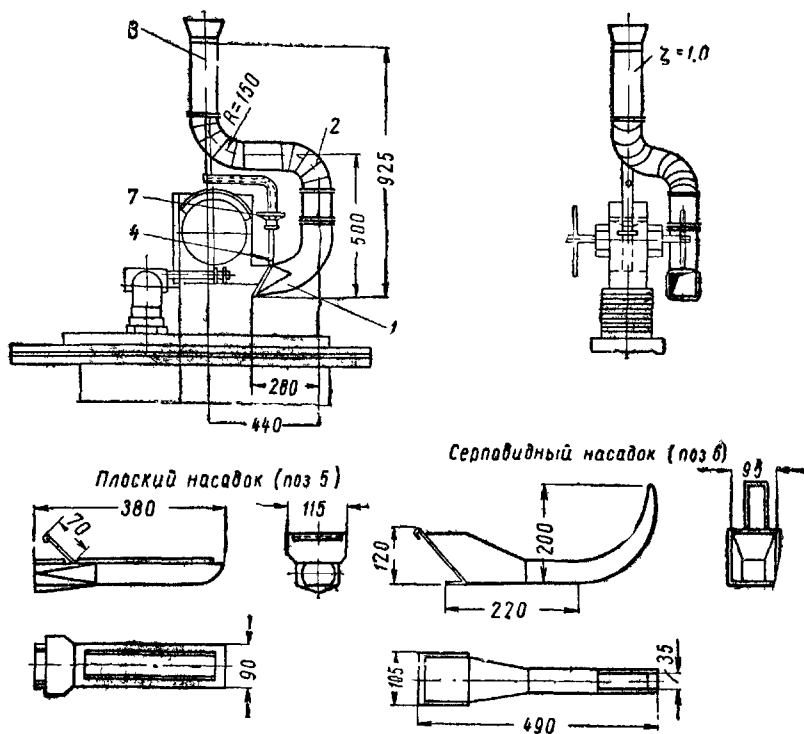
Местный отсос от универсально-заточного станка 3А64
